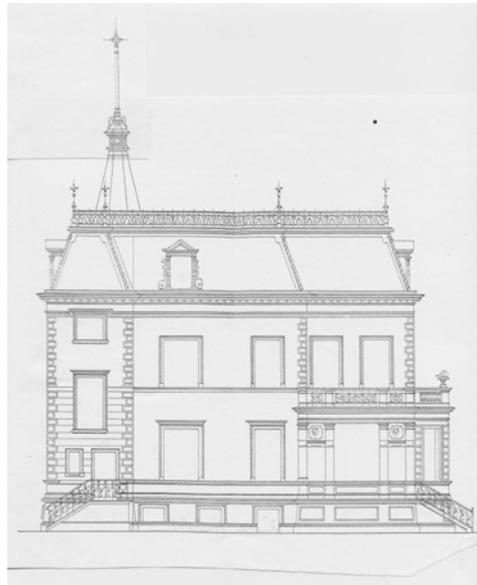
H. Plange, Aufriss Hintere Fassade, 1889
